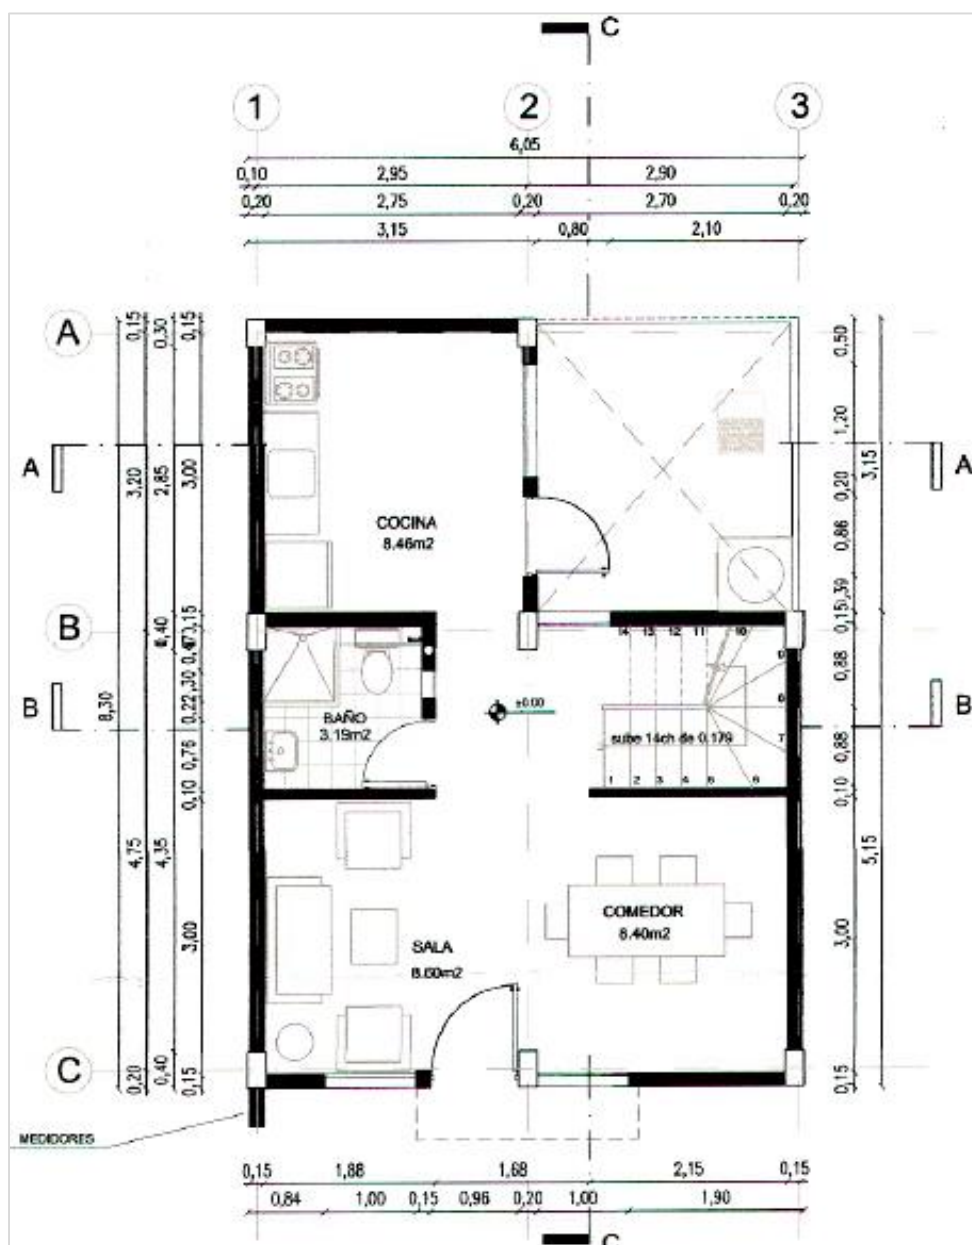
PLANTA BAJA. Vivienda Tipo C41-P9. Proyecto Ciudad Bicentenario.
